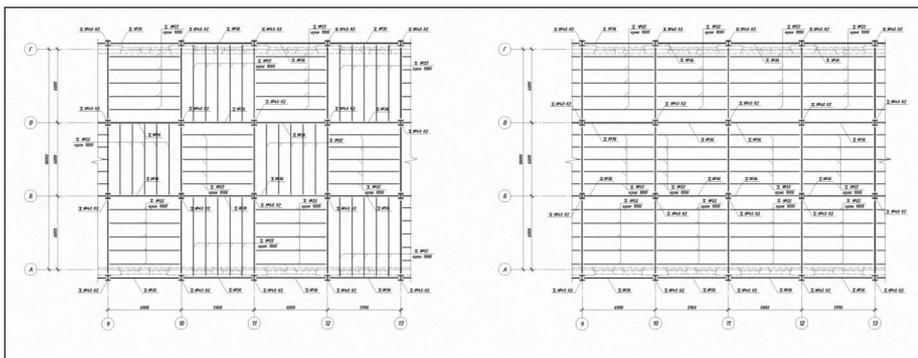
Возможное размещение балок перекрытия в разных направлениях
